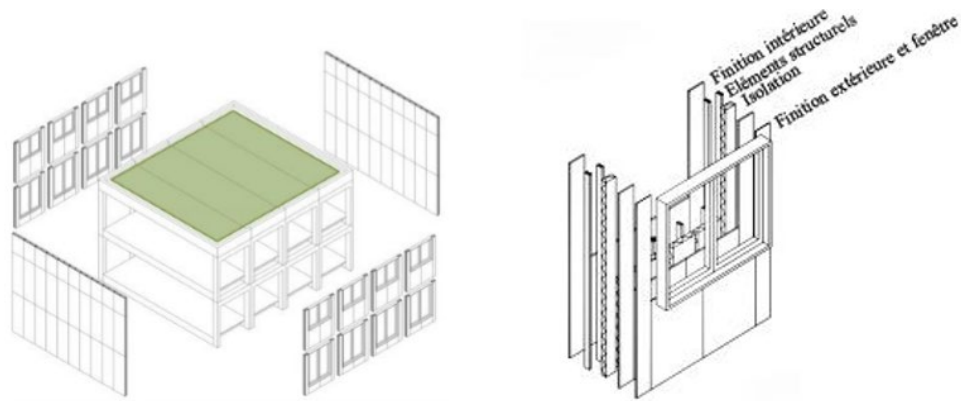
Démontabilité de la façade ; détail du module de façade
